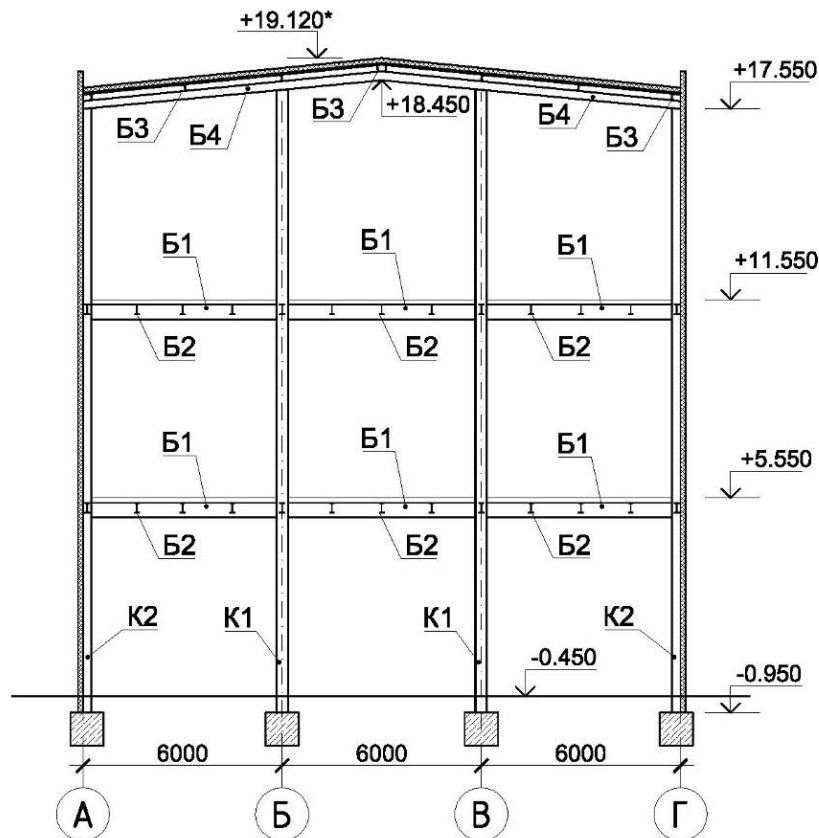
Схематичний поперечний розріз виробничої будівлі
